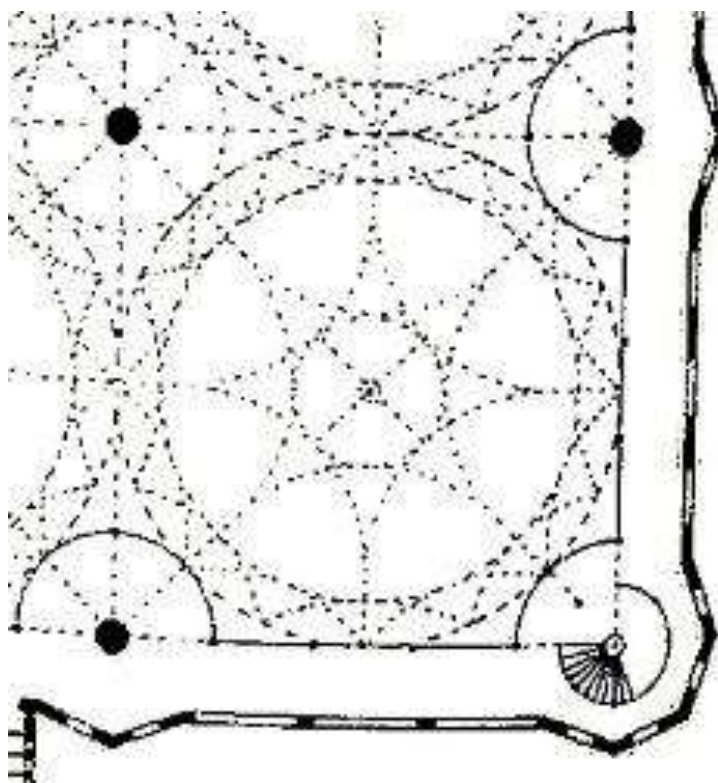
Detalle de las escaleras de la sala de fiestas de Anatole de Baudot, de 1910.
